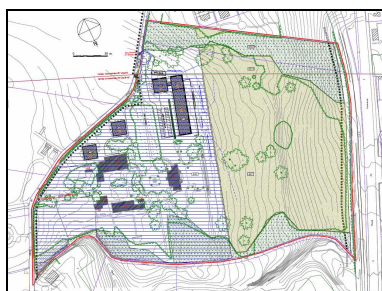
Le Grand-Malagny, plan localisé de quartier (29160) valant plan de site
